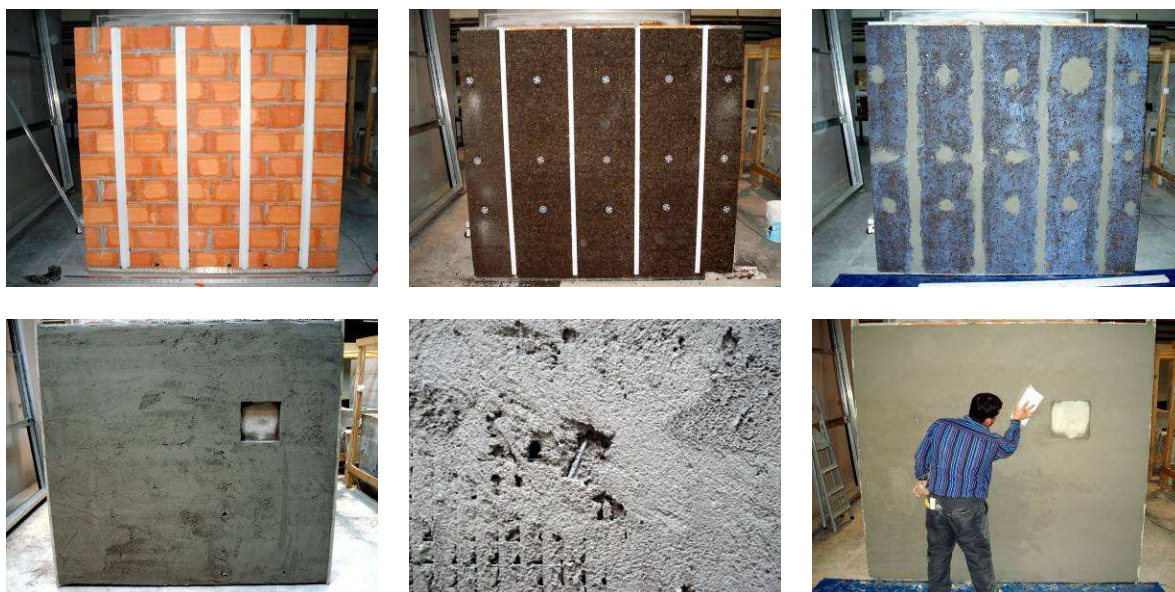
Provede durante a construção (Adaptado de Machado *et al.*, 2008).
